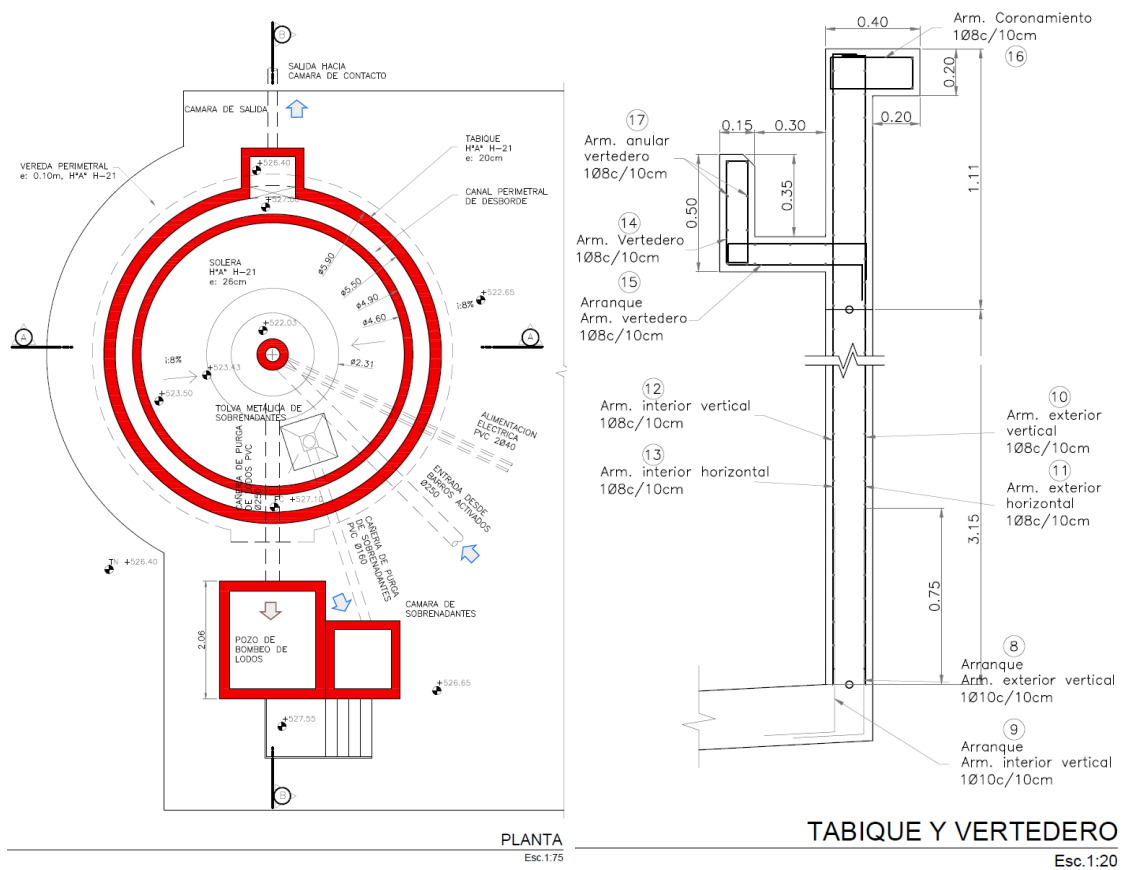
Planta y sección de Estructura de Sedimentador
